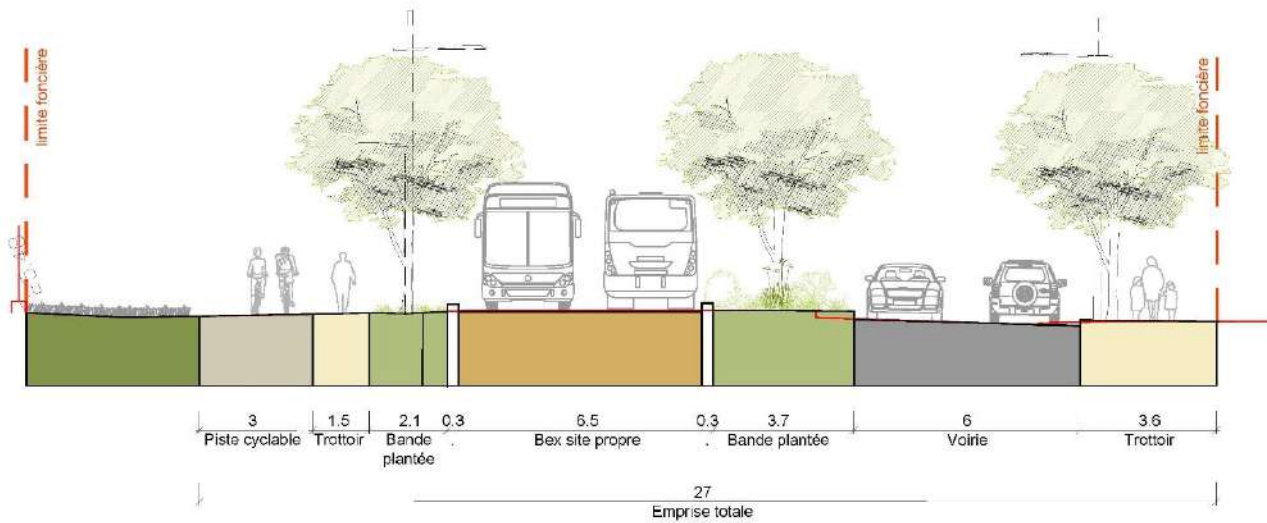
Coupe type sur l'avenue de Thouars Sud
